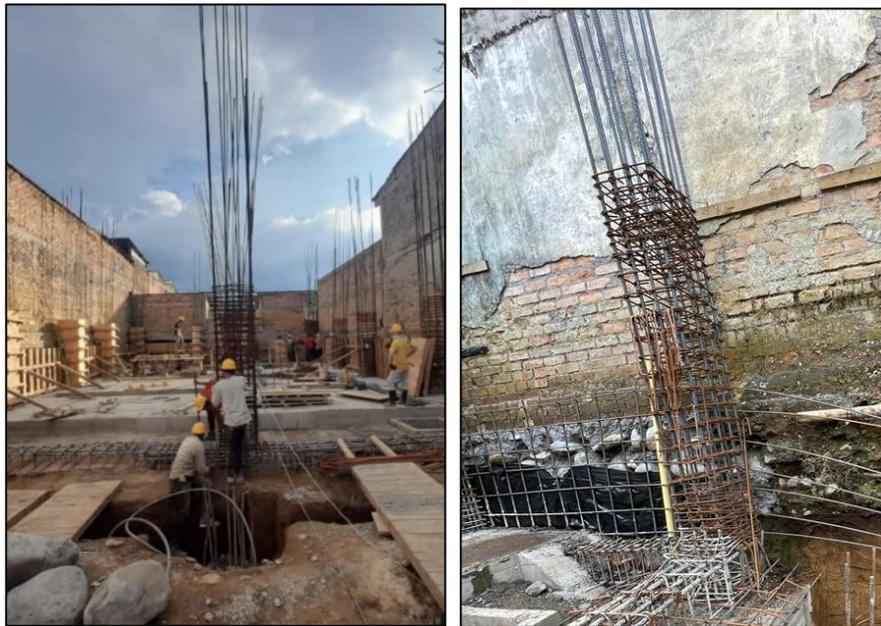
, Armado de Columnas eje 9, Fuente: Elaboración propia.
